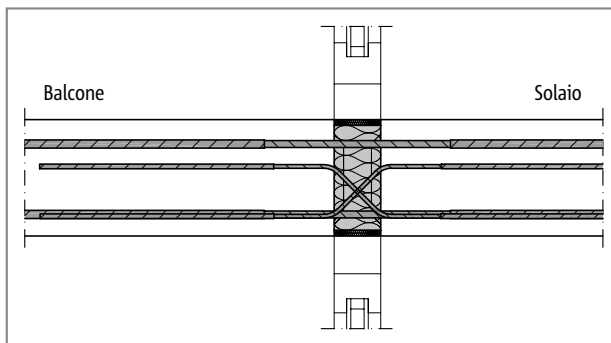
Schöck Isokorb® T tipo KP: sezione costruttiva; solaio monodirezionale
